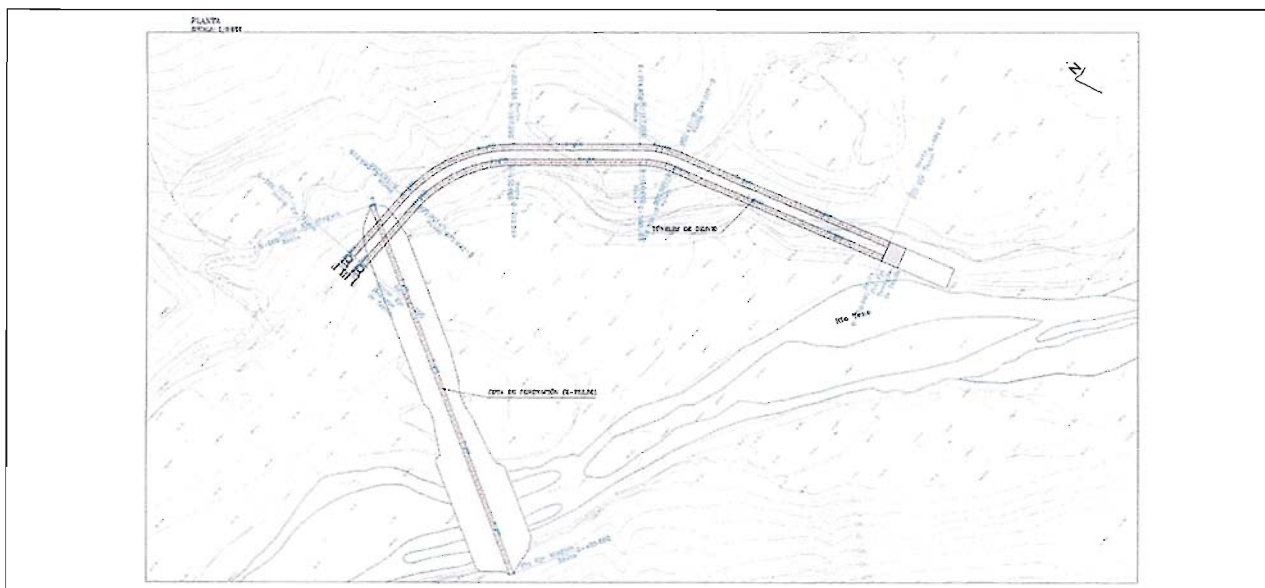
Plano de Planta, Vista Túneles de desvío. Alternativa La jaula 1
